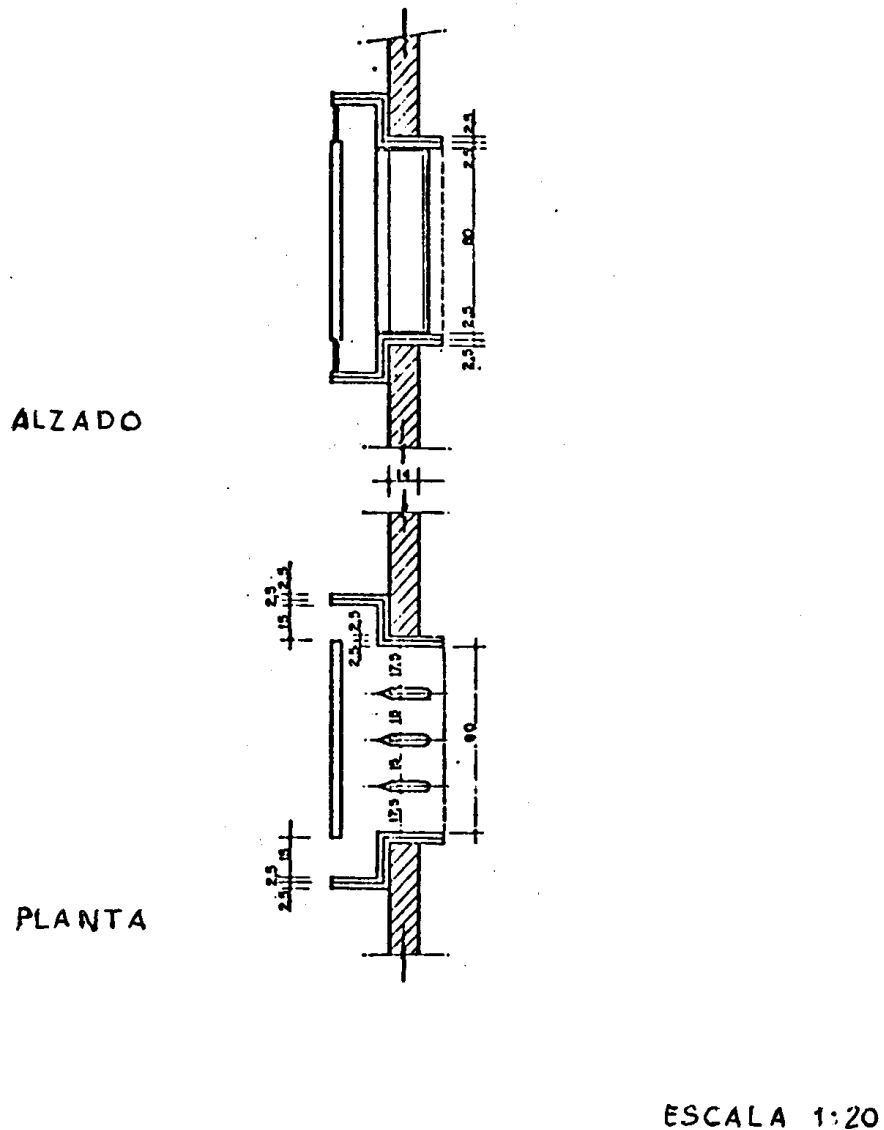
Sección y planta del silencioso colocado en las entradas y salidas de aire.
